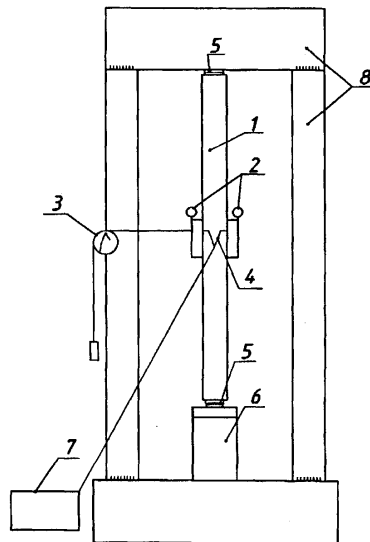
Схема установки для проведения кратковременных испытаний основных образцов: 1 - образец; 2 - индикаторы; 3 - прогибомер системы Максимова; 4 - провода тензодатчиков; 5 - шарнирная опора; 6 - гидравлический домкрат; 7 - цифровой вольтметр; 8 - сварной стальной портал
